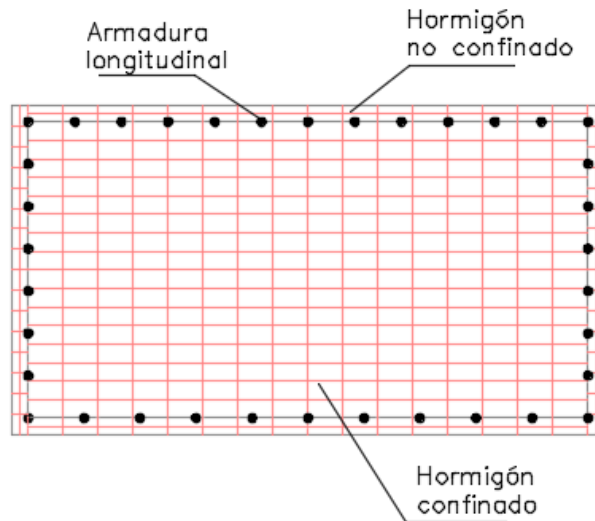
Discretización con fibras en viga cabecera de hormigón armado en puente de la clase VH-SATM.
